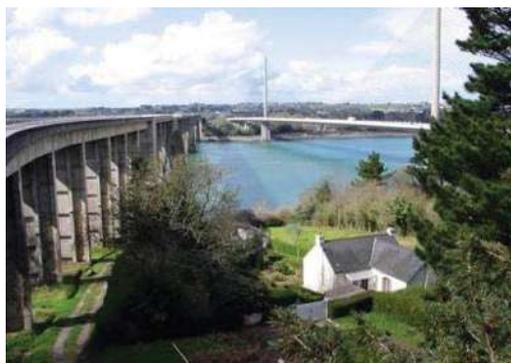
Puente Plougastel, junto al puente l'Iroise, cerca de Brest, Francia. El Ingeniero Freyssinet logró construir el puente para cruzar el río Elorn hecho de hormigón armado y pretensado, está compuesto por 3 arcos de doble carril de 186.5 m de luz entre ejes y un tablero de dos pisos, el superior con 6 m de calzada y dos andenes de 1 m y el inferior para una vía de ferrocarril, con una longitud total de 900 m de largo y 42.5 m de altura. Las obras comenzaron en 1926 y fue inaugurado el 9 de octubre de 1930 [2].
